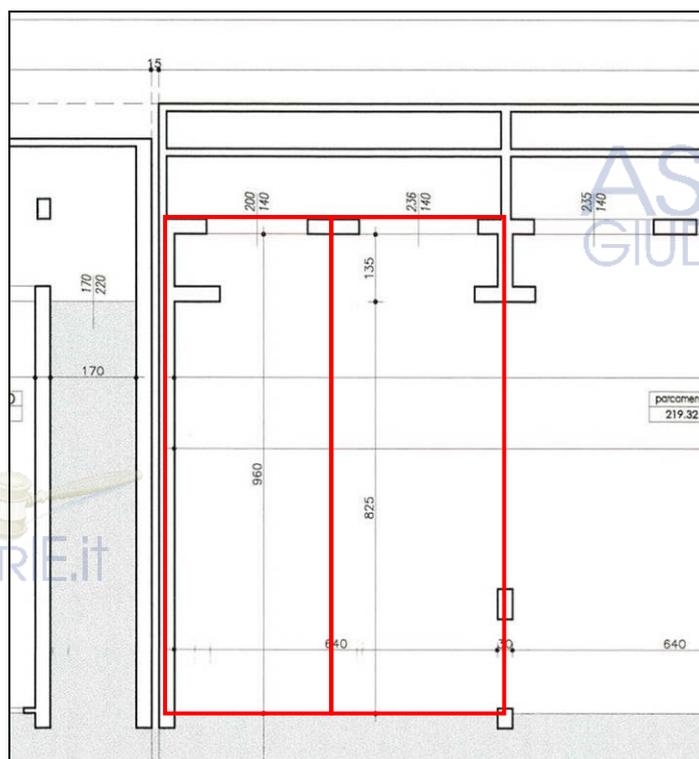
Estratto pianta piano secondo interrato D.I.A. Prot. 14989 del 14.04.2007
